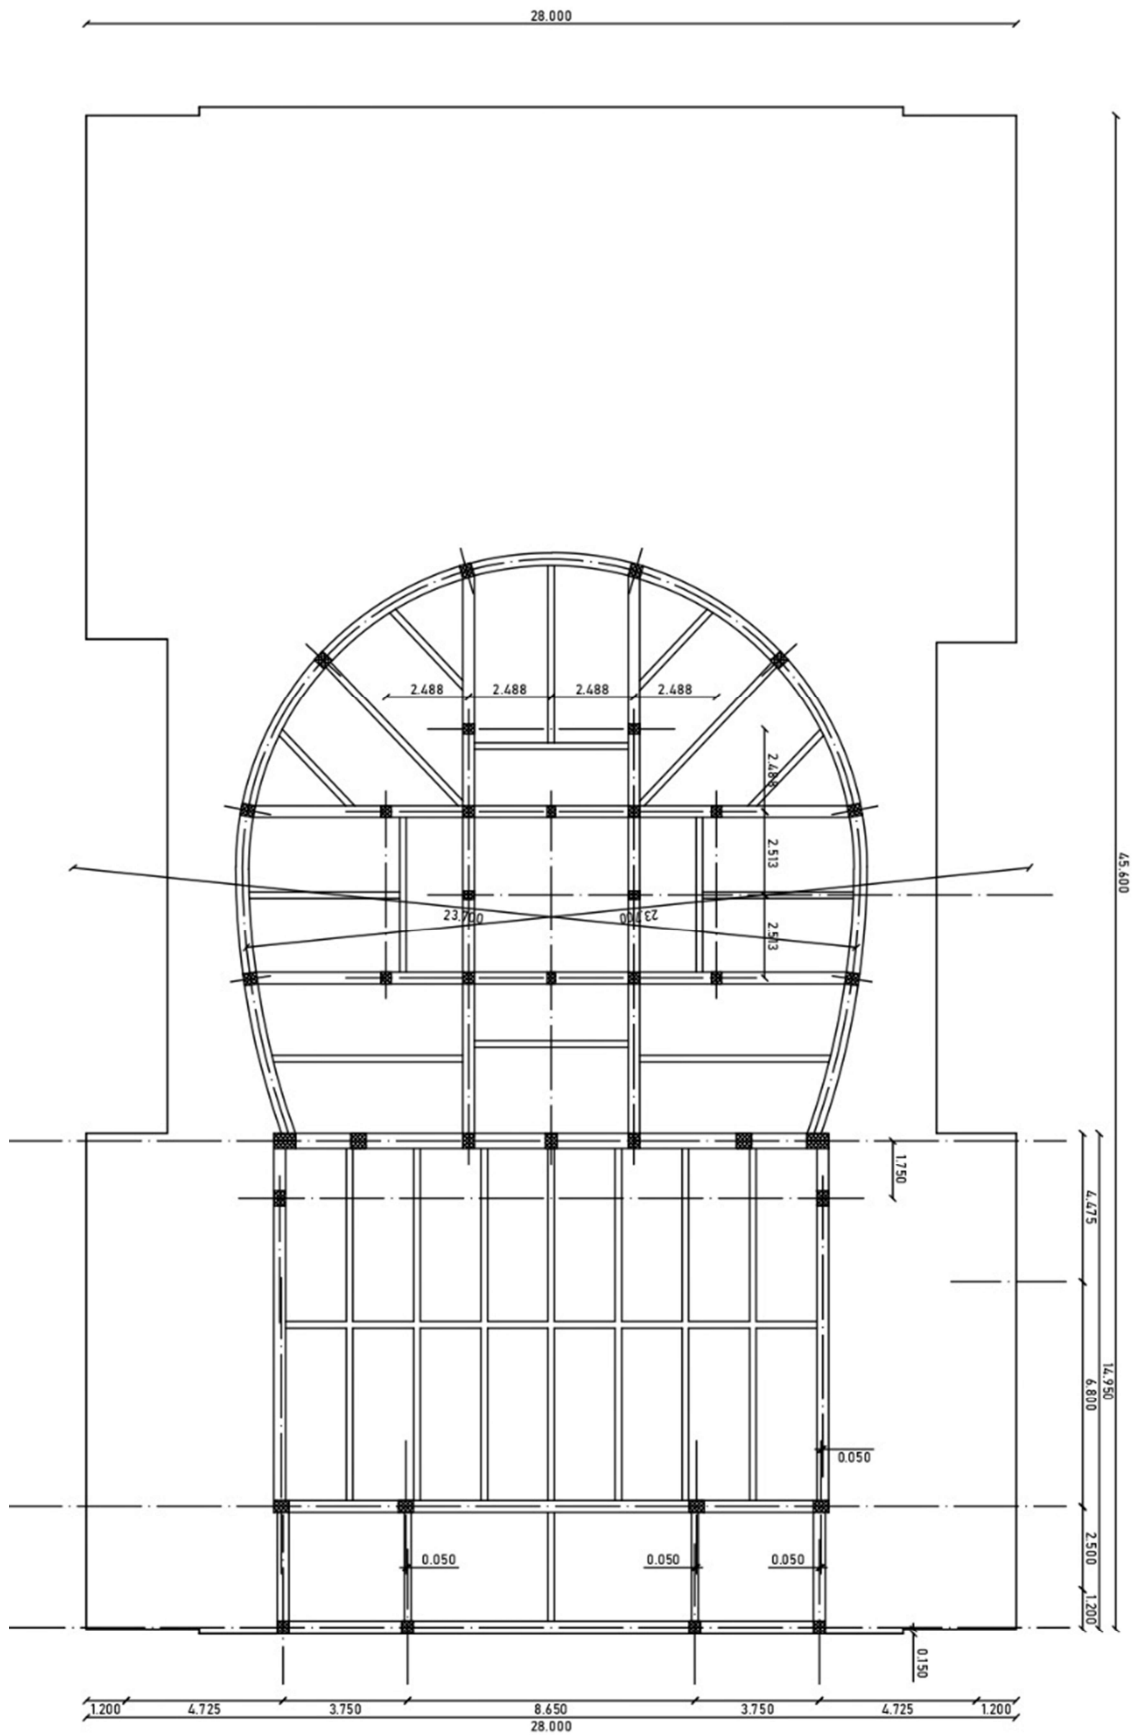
Pianta pilastri e puntoni lucernario, solaio copertura torre scenica
